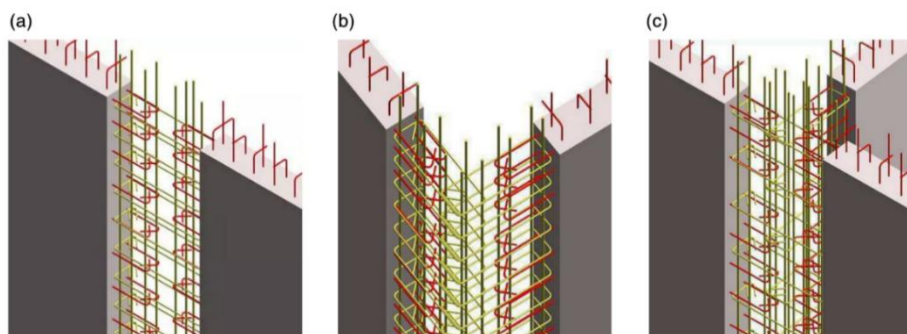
Exemplos de ligações verticais húmidas in situ entre paredes prefabricadas: a) Tipo I; b) Tipo L; c) Tipo T; adaptado de [26].
